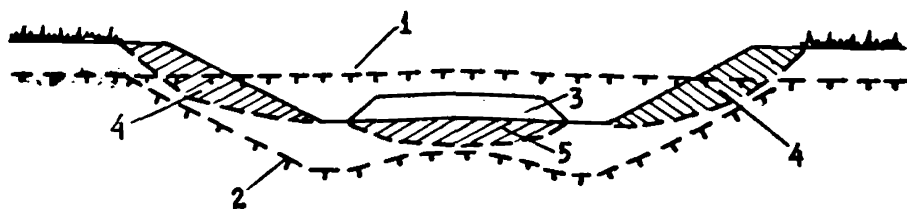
Деформации в выемках, сооружаемых в вечномёрзлых грунтах: 1 - ВГМ до сооружения выемки; 2 - ВГМ после сооружения выемки; 3 - балластный слой или основание дорожного покрытия; 4 - зона сползания откосов; 5 - осадка верхней площадки земляного полотна
